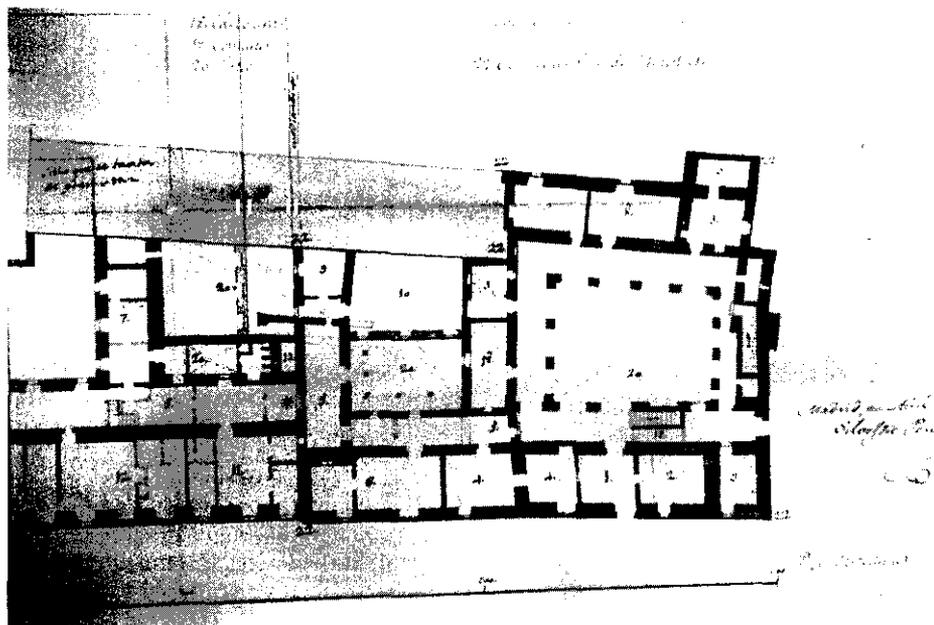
Plano de la planta baja del palacio de los Maestres, realizado en 1808 por Silvestre Pérez (cortesía del AHN).
